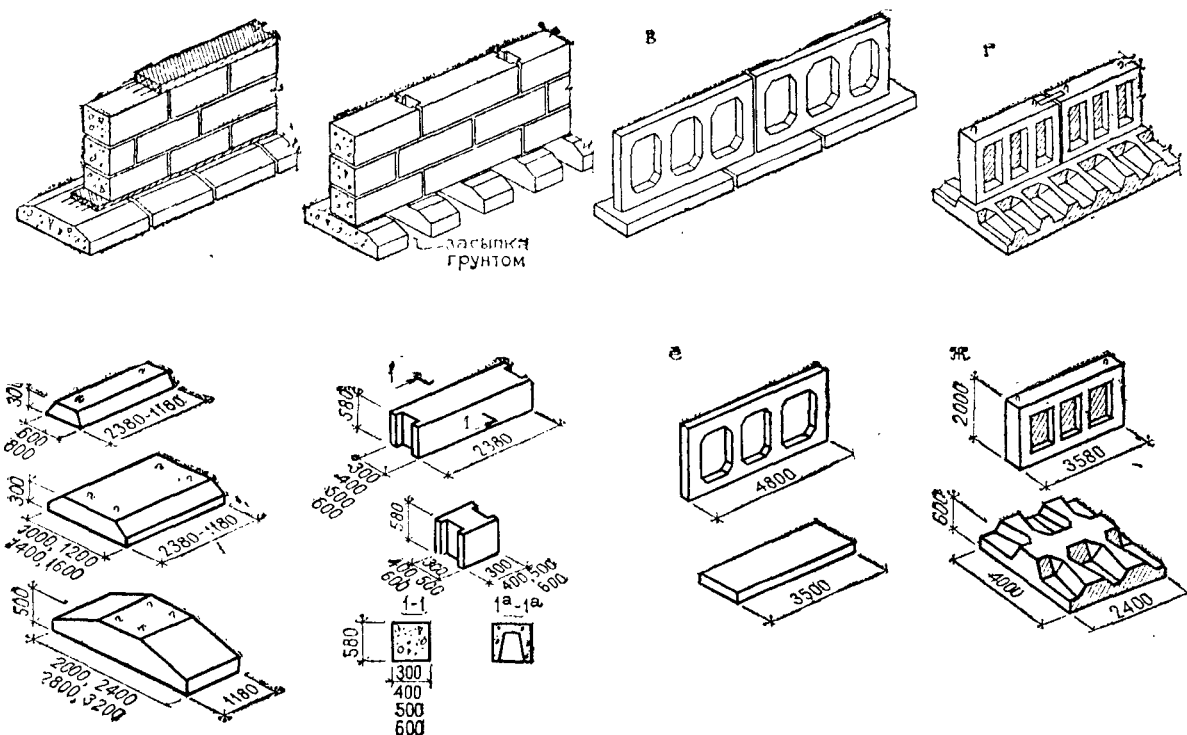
Сборные бетонные и железобетонные фундаменты
